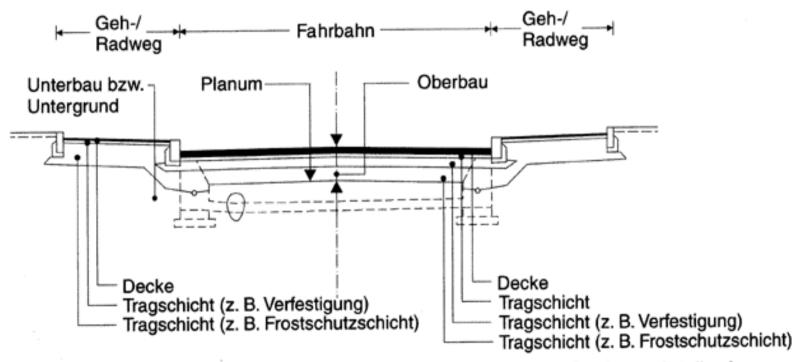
Beispielhafter Aufbau einer Befestigung in geschlossener Ortslage mit teilweise wasserundurchlässigen Randbereichen sowie mit Entwässerungseinrichtungen
